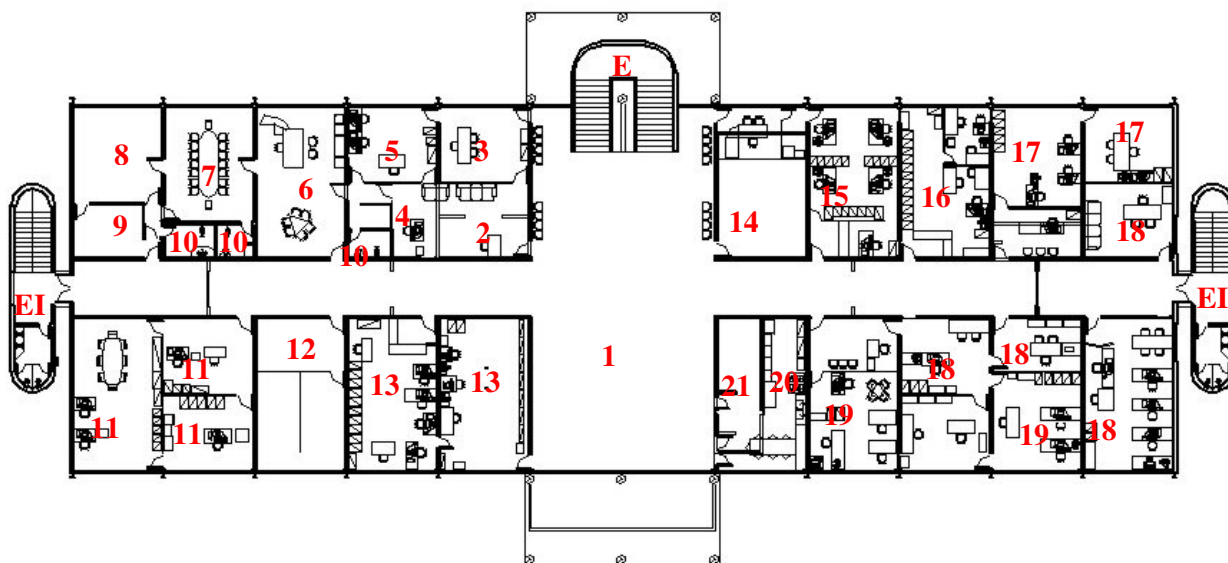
Prefeitura Municipal de Mariana – Segundo Pavimento – Planta Baixa.
